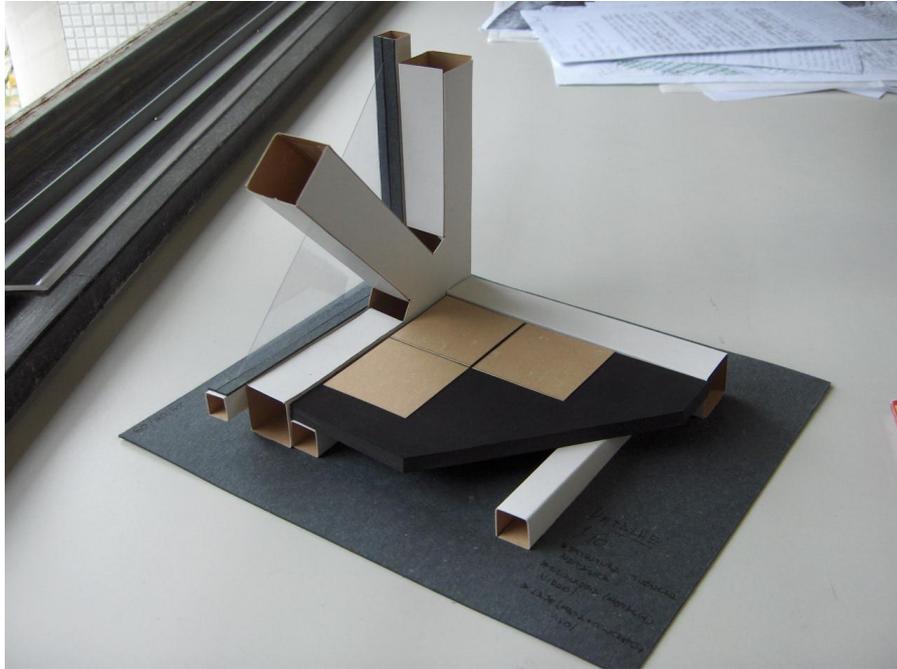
TRABALHO DE ALUNO - Maquete detalhe construtivo
